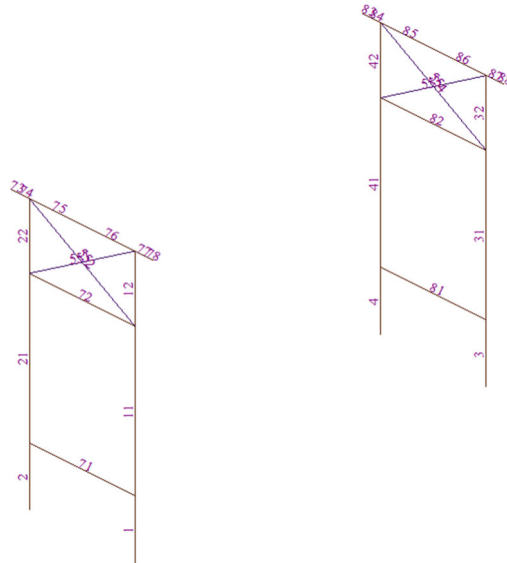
Vista in pianta modello FEM – Impalcato e Pile
